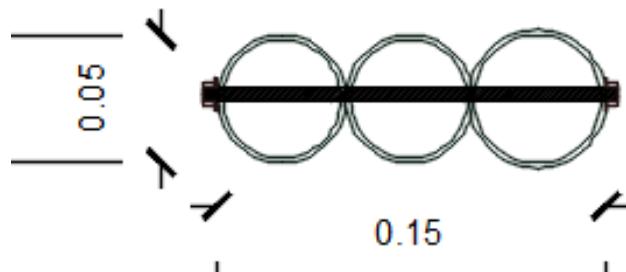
Elaboración propia, Planta detalle de anclaje en bambú
